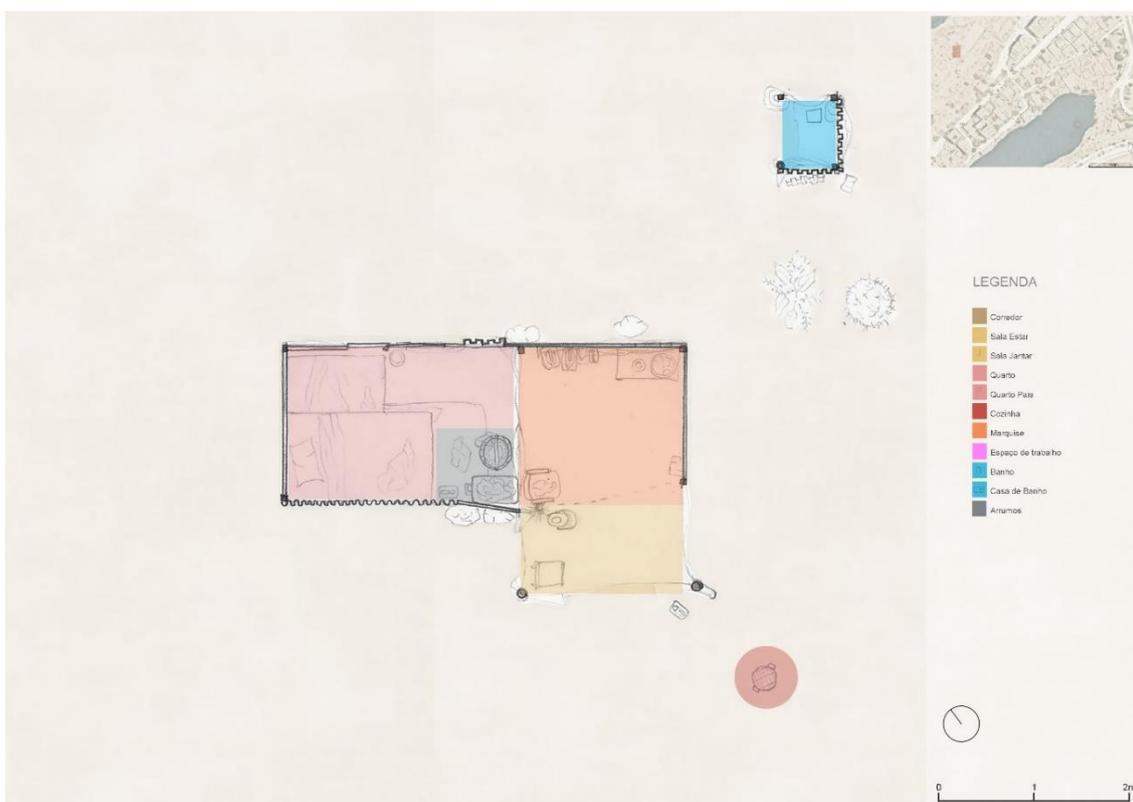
Uso da Casa 5, em 2020. Levantado e desenhado pela autora.
